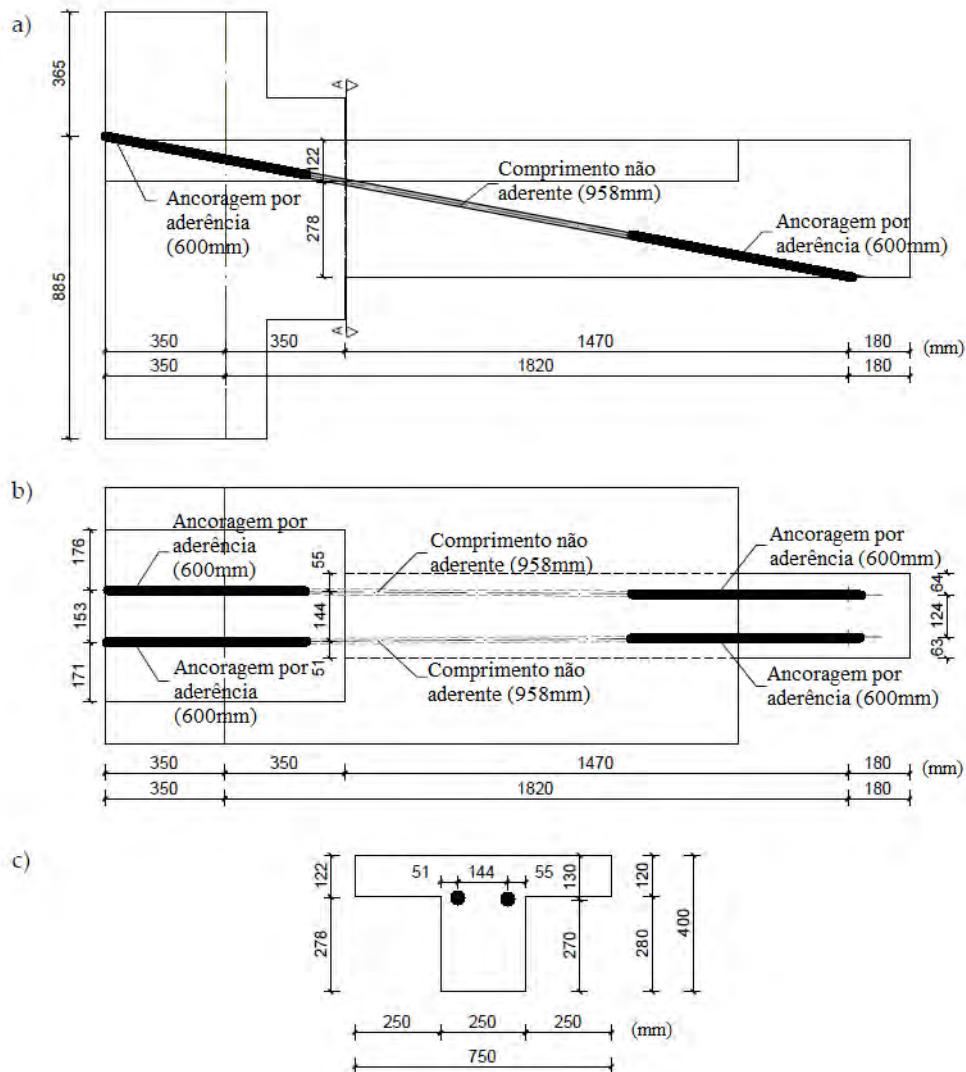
Geometria do traçado dos cordões de pré-esforço na viga CB3 (conforme construído): a) alçado, b) planta e c) corte A-A' (adaptado de [49]).
